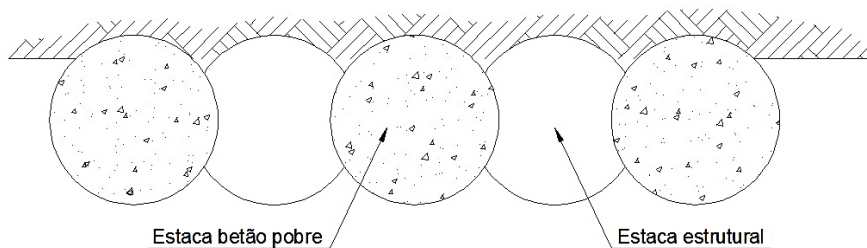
Cortina de estacas com enchimento em betão pobre.
